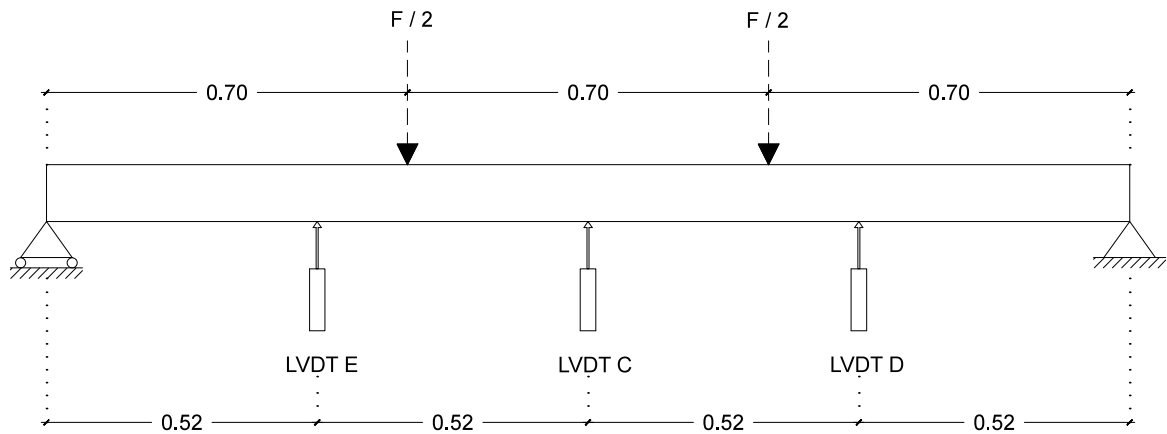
Representação da posição dos LVDTs ao longo da viga (medidas em m).
